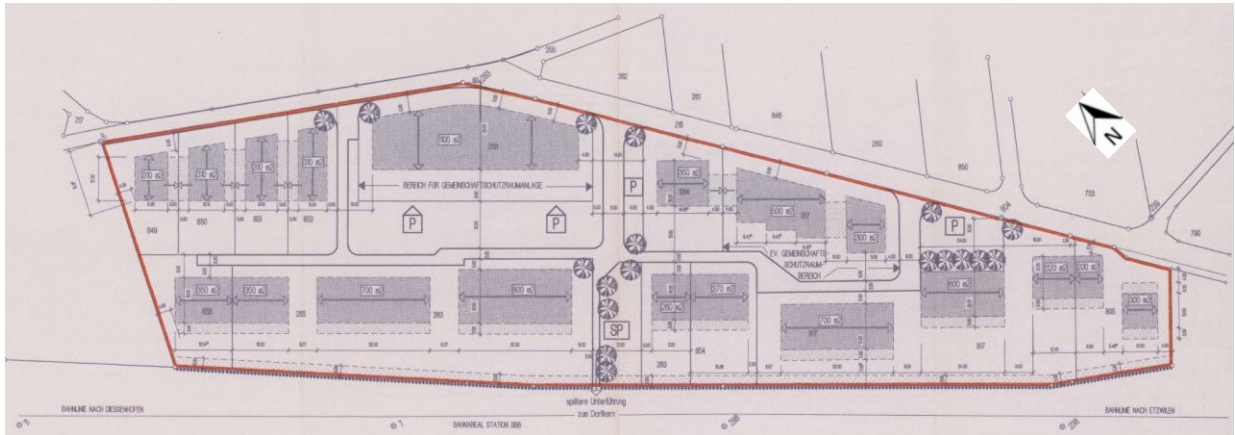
Planausschnitt Gestaltungsplan 'Zelgli'
